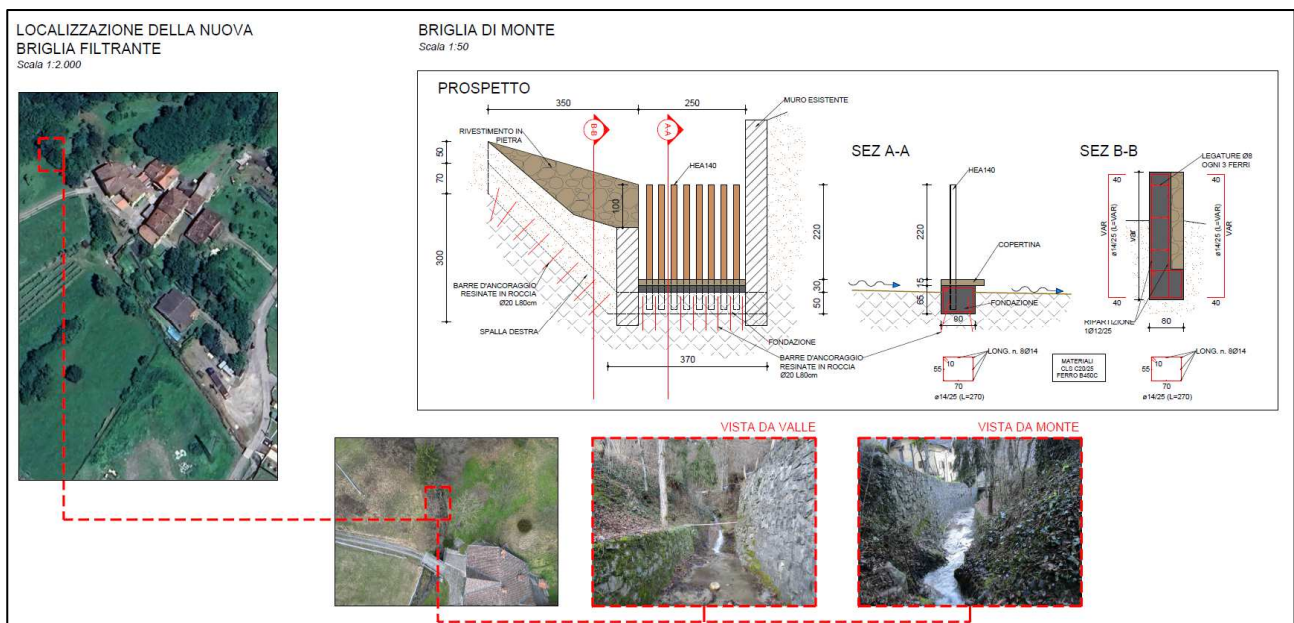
Stralcio della planimetria di progetto e della briglia di monte.
